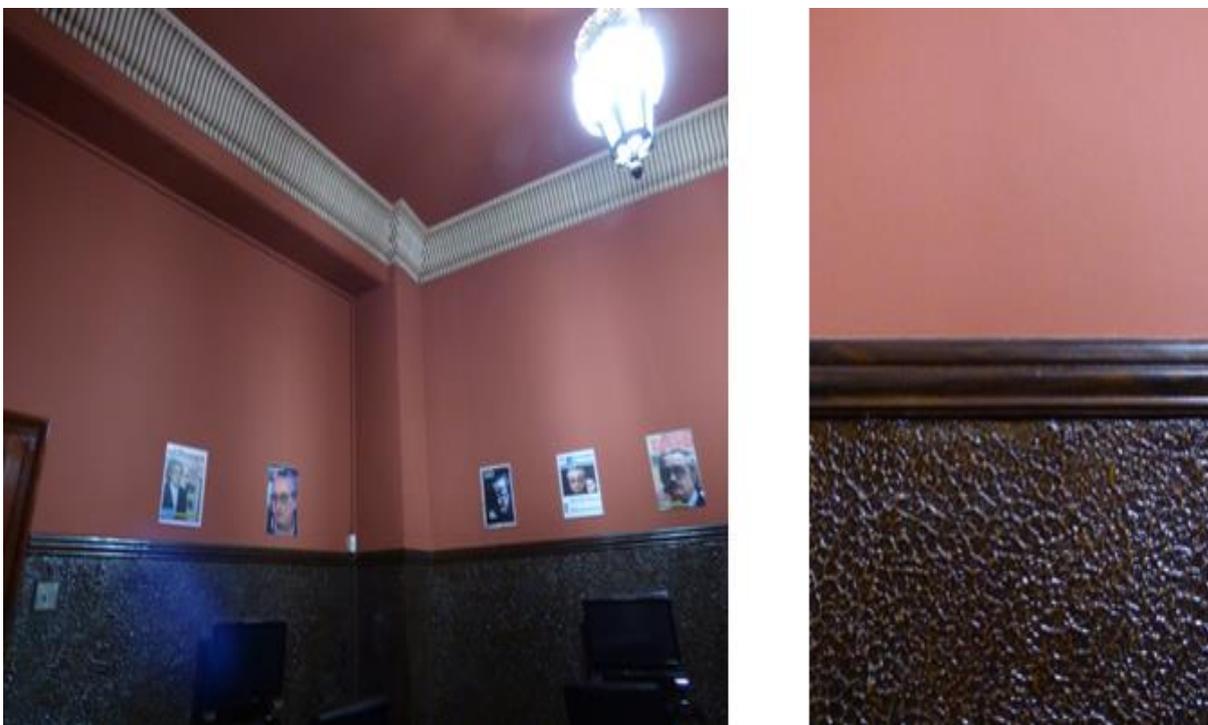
Estucado con moldura de la zona del despacho de la planta baja.
